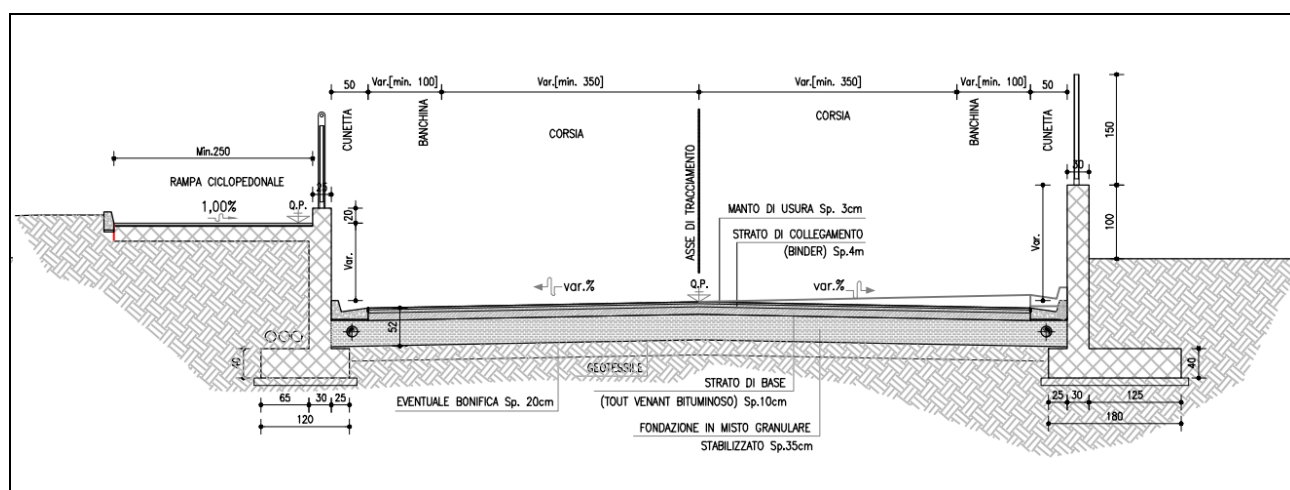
Sezione tipo asse principale con pista ciclopedonale e muro di contenimento
